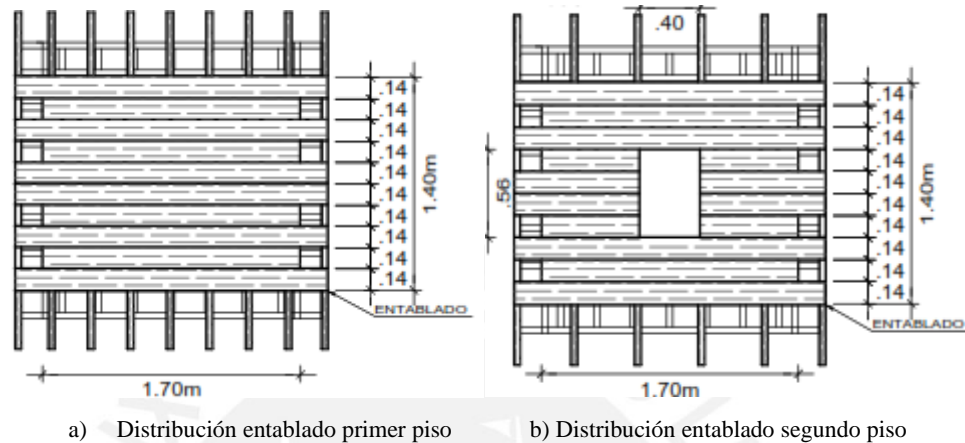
Vista en planta del entablado del primer y segundo piso, respectivamente
